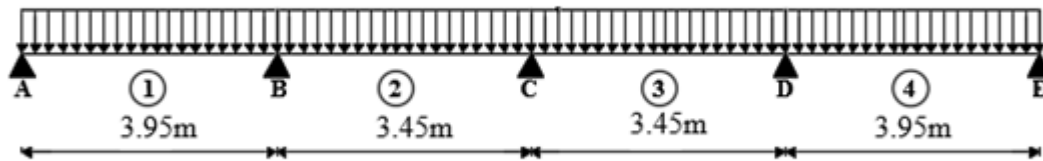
Schéma du 1^{ère} type de poutrelle
